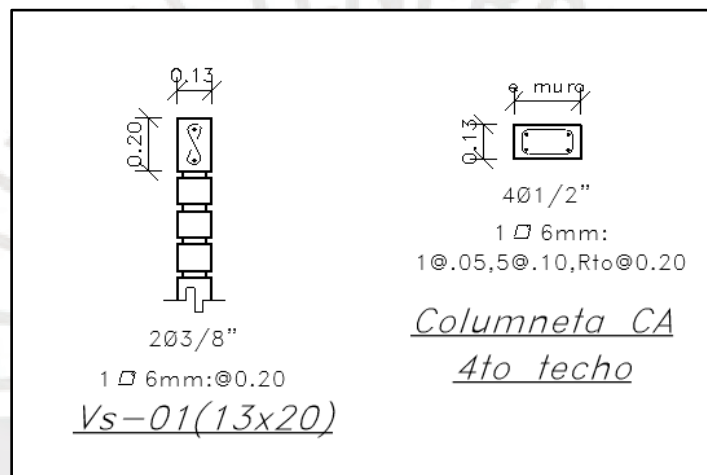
Secciones de columnetas y vigas de arriostre en muros no portantes
